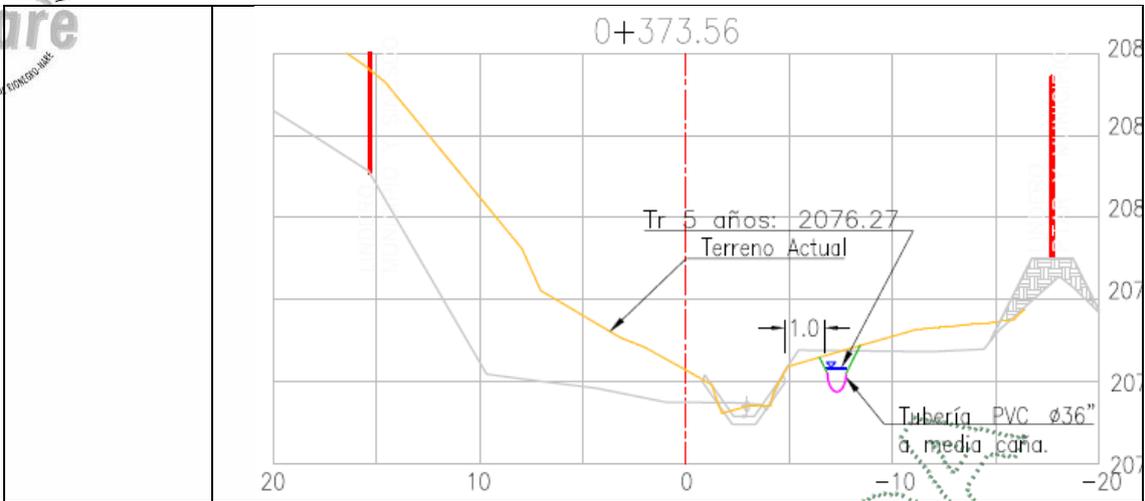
Tipo de la Obra:			Jarillón Sur
